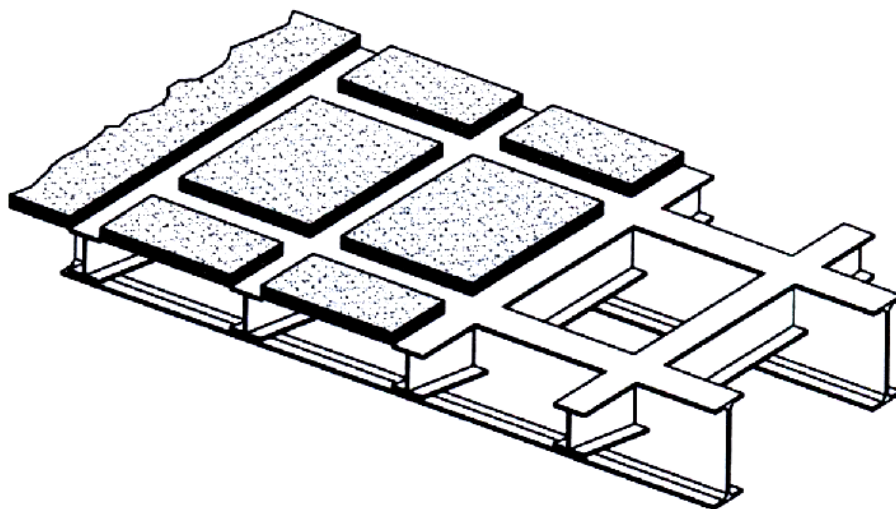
Сборные железобетонные плиты объединяемые с главными и поперечными мостовыми балками с помощью сварки [7]
